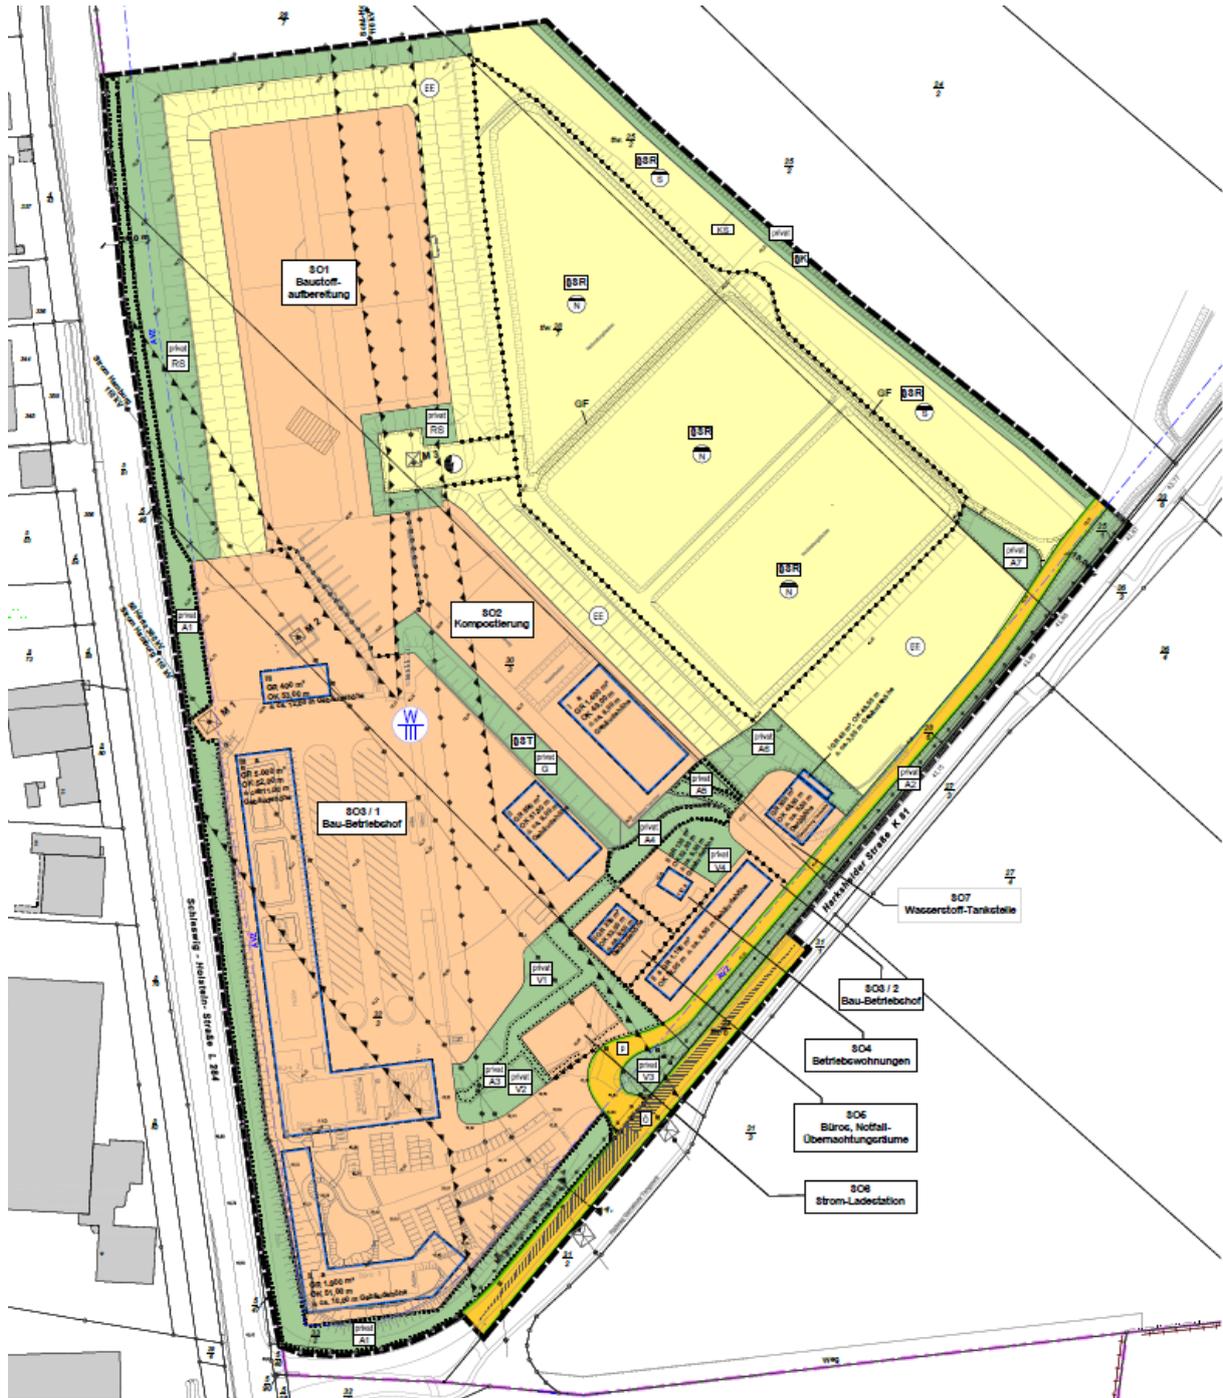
B-Plan 37 Gemeinde Tangstedt (PROKOM, Stand: 12.03.2024)
